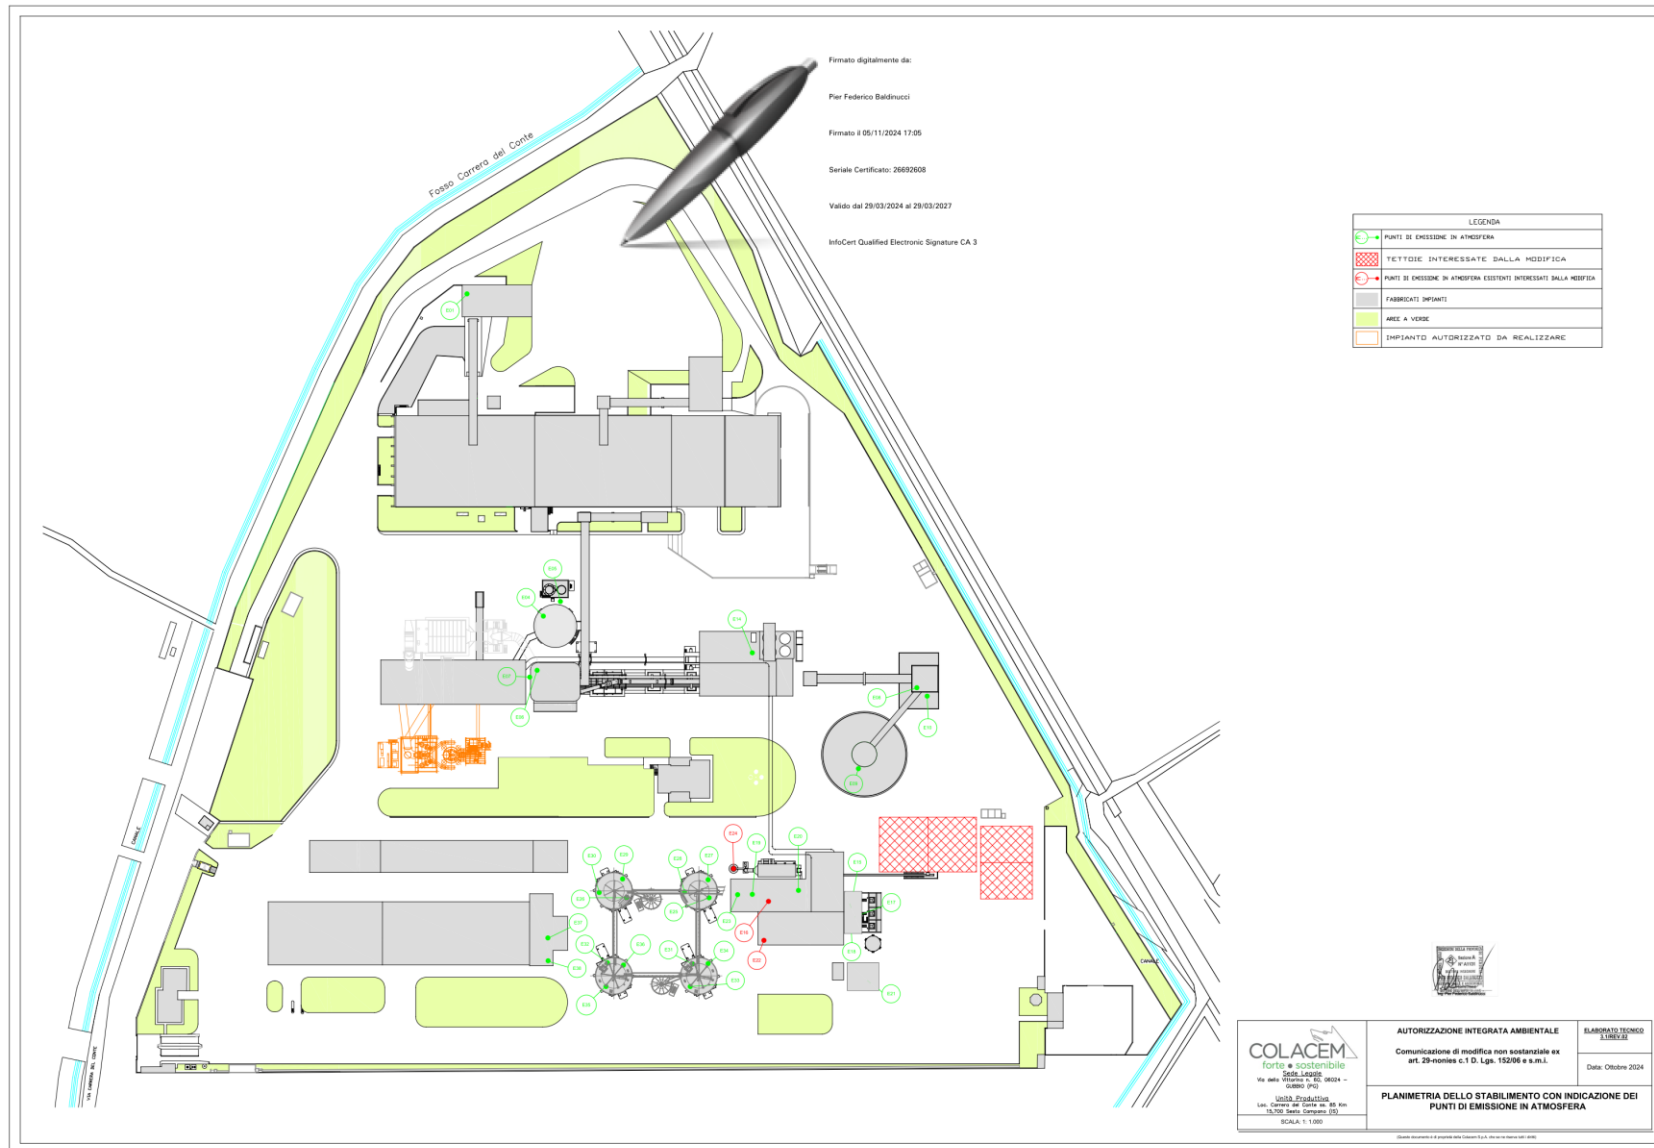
planimetria generale dell'installazione con indicazione degli impianti interessati dalle modifiche progettuali
